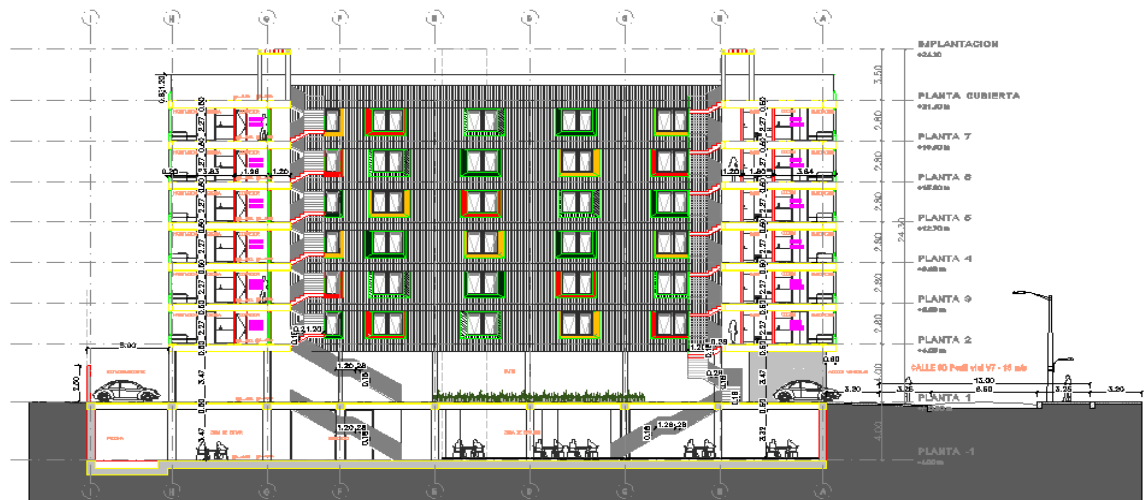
PLANO ARQUITECTÓNICO DEFINITIVO – AP CUB bind.
